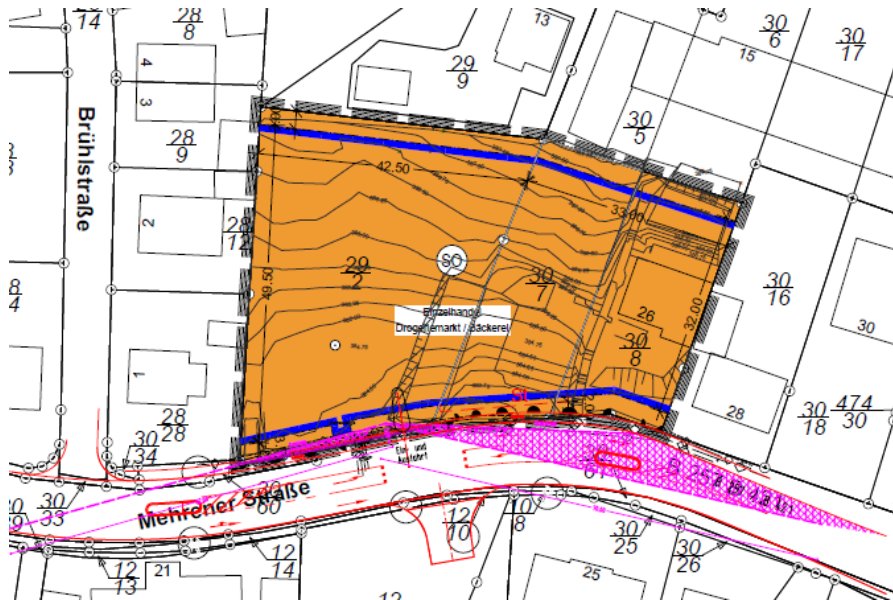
Bebauungsplan „Mehrener Straße 22 -26“ nördlicher Teilbereich, Quelle WeSt-Stadtplaner GmbH
